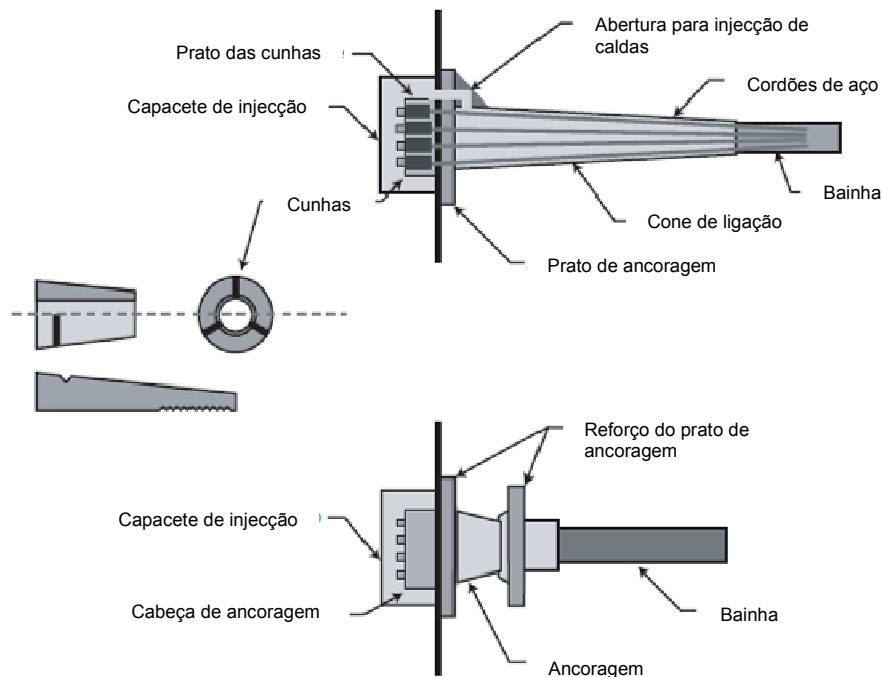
Sistema de pós tensionamento - ancoragens para armaduras internas aderentes [adaptado de [55]]
